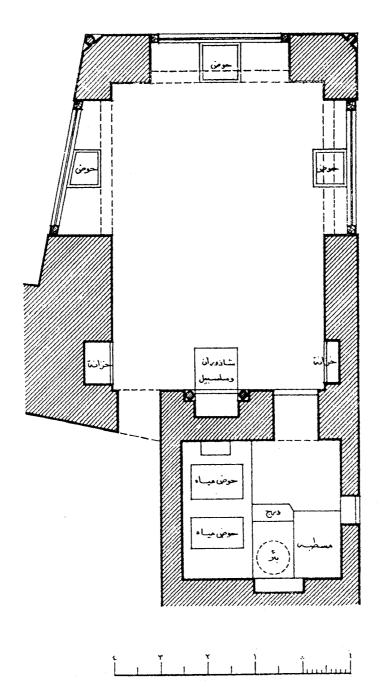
مسقط أفقي لقبة رقية دودو (عن سوسن سليمان) .
